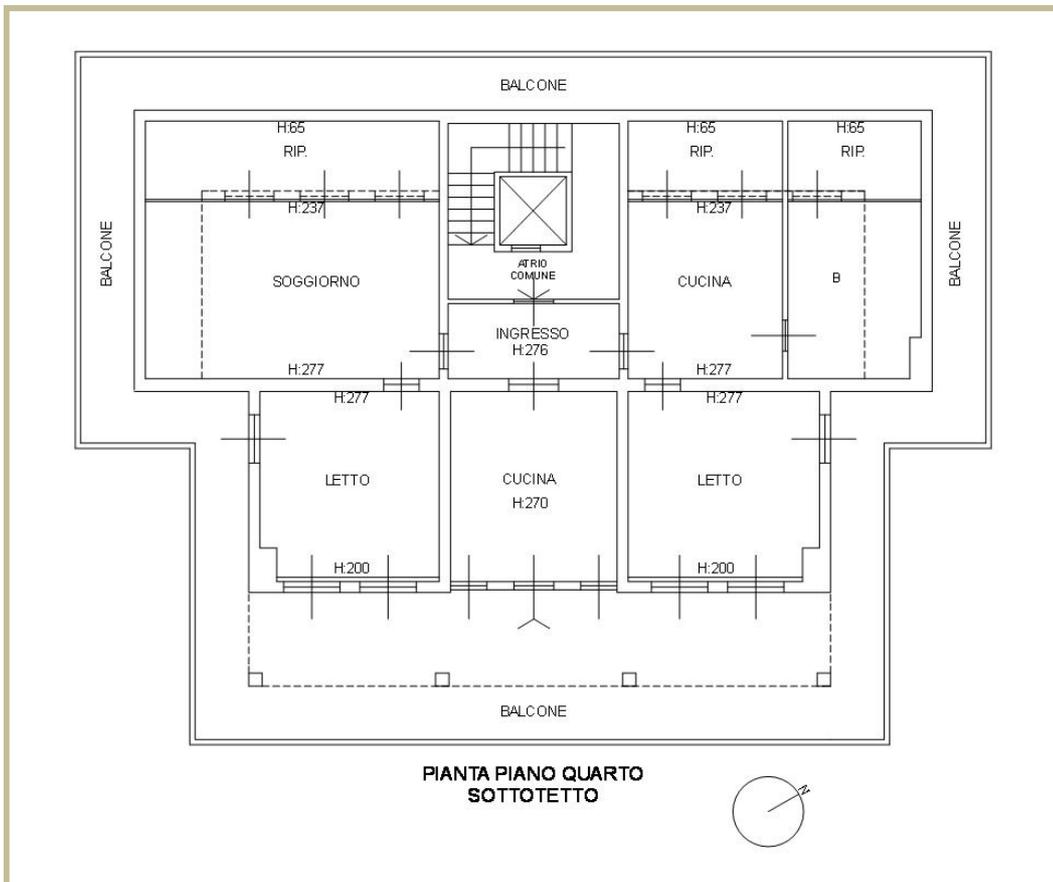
PIANTA P4 SOTTOTETTO STATO DI FATTO REALIZZATO
